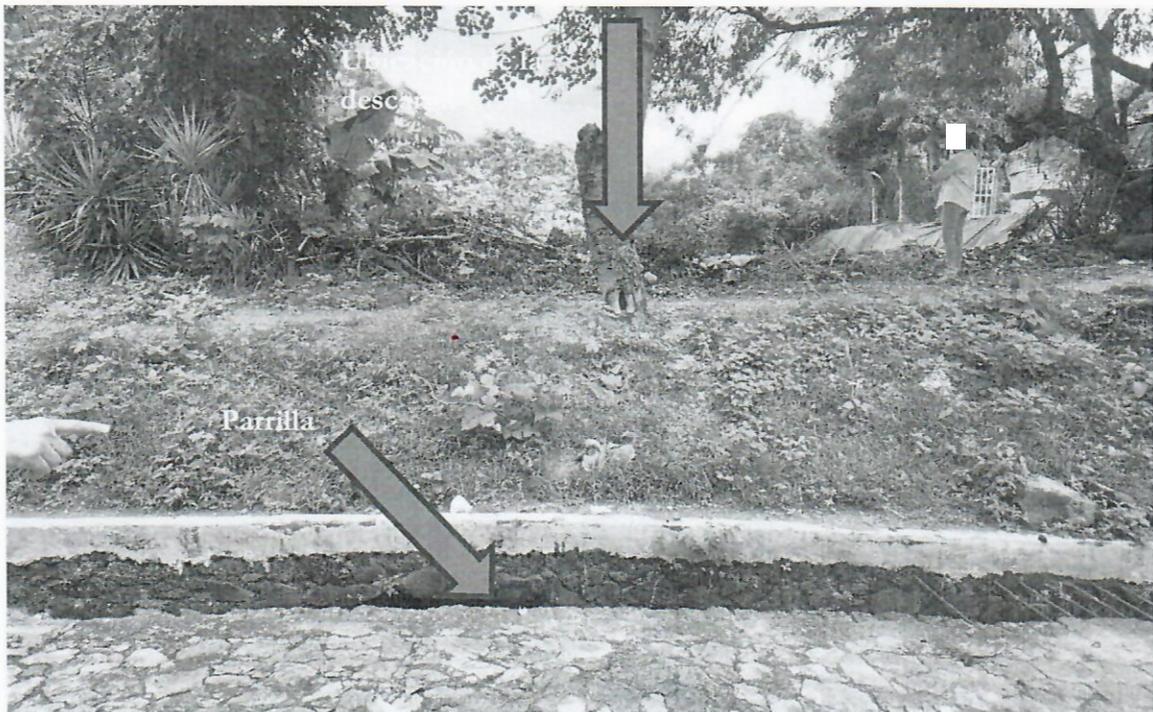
Vista general de Final del Pasaje Las Lilas.
